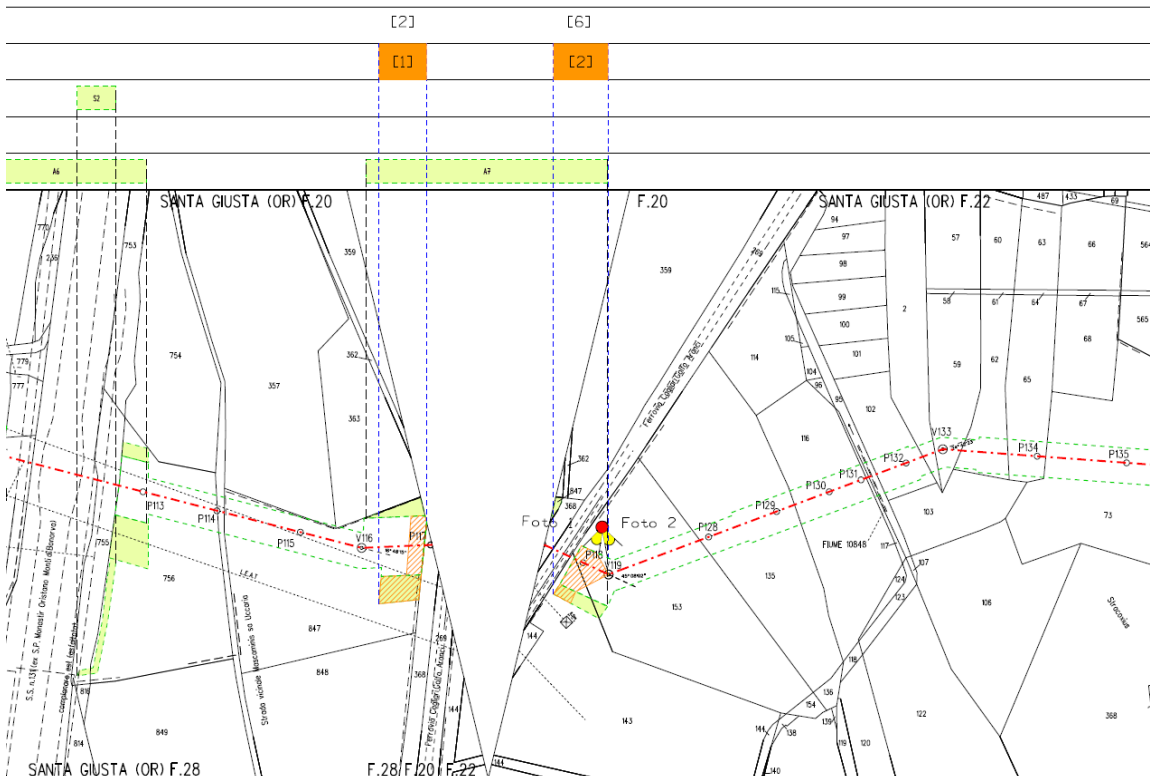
Tratto P118 – V119+ALL. A7 - la zona delimitata dalle linee verdi rappresenta la fascia ristretta di lavoro per come previsto dalla GASD C 13.40.10.02
